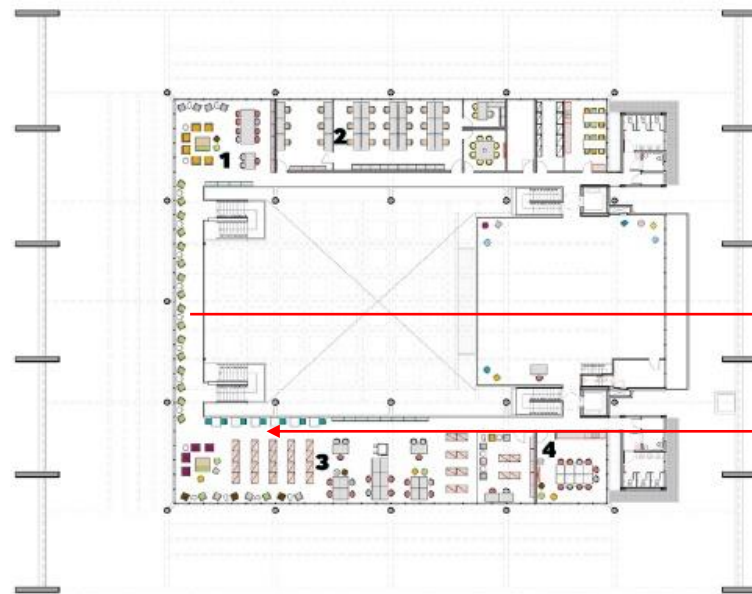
Planta baixa 2 pavimento Biblioteca Villa Lobos. Fonte: Archdaily (2019a).
